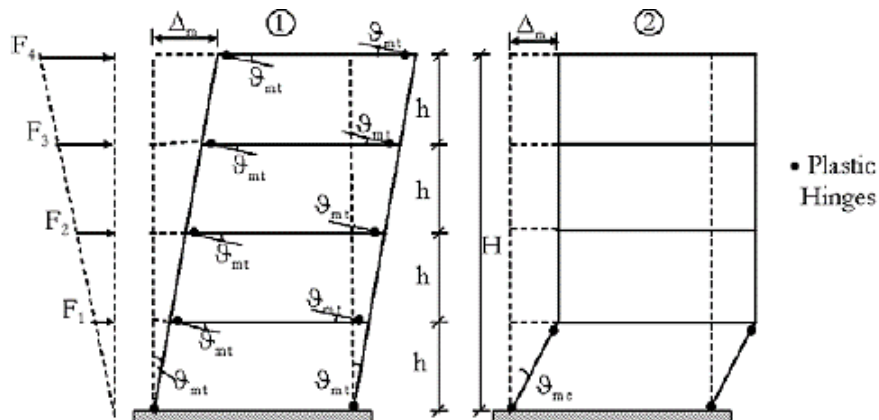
Mécanismes de rupture pour les constructions en poteaux-poutres [50]
